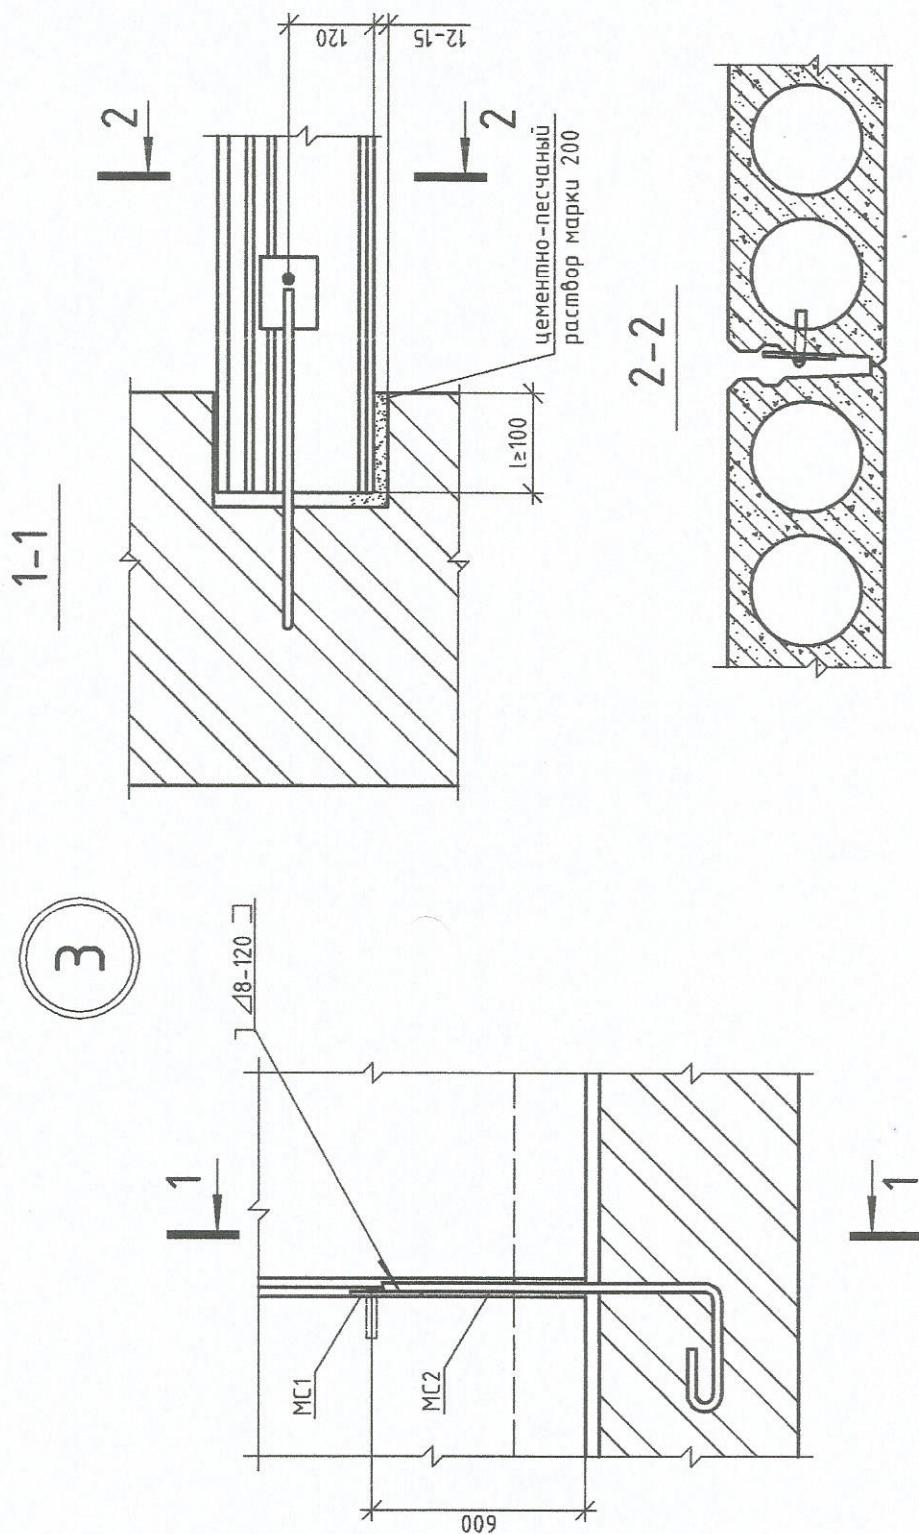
Конструкция щэла 3 согласно монтажной схеме
